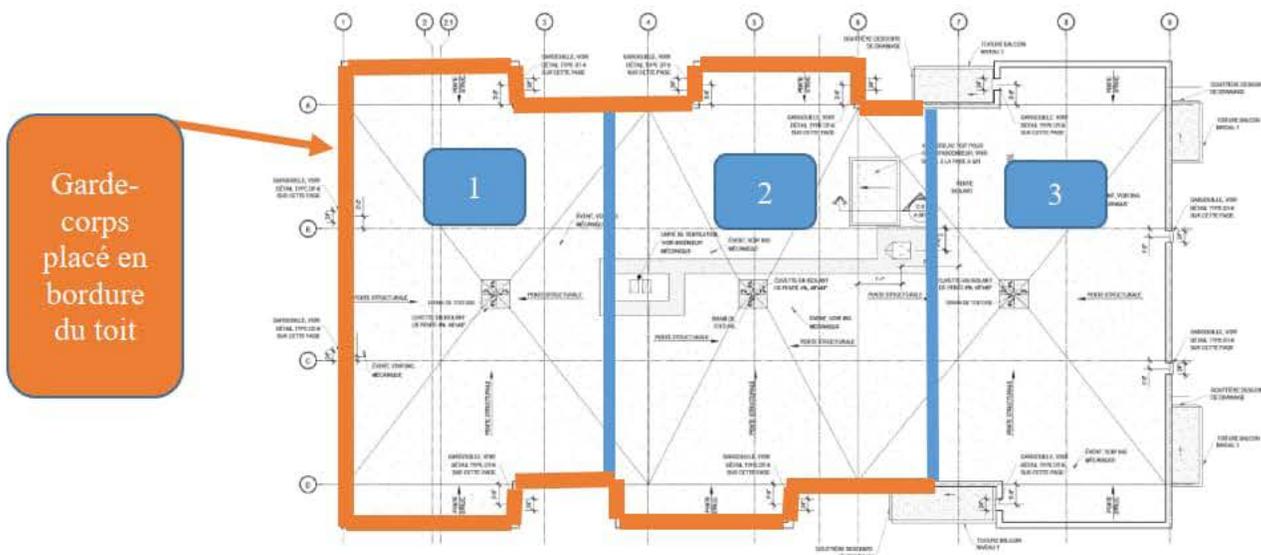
Plan toiture avec garde-corps et divisé par bassins
